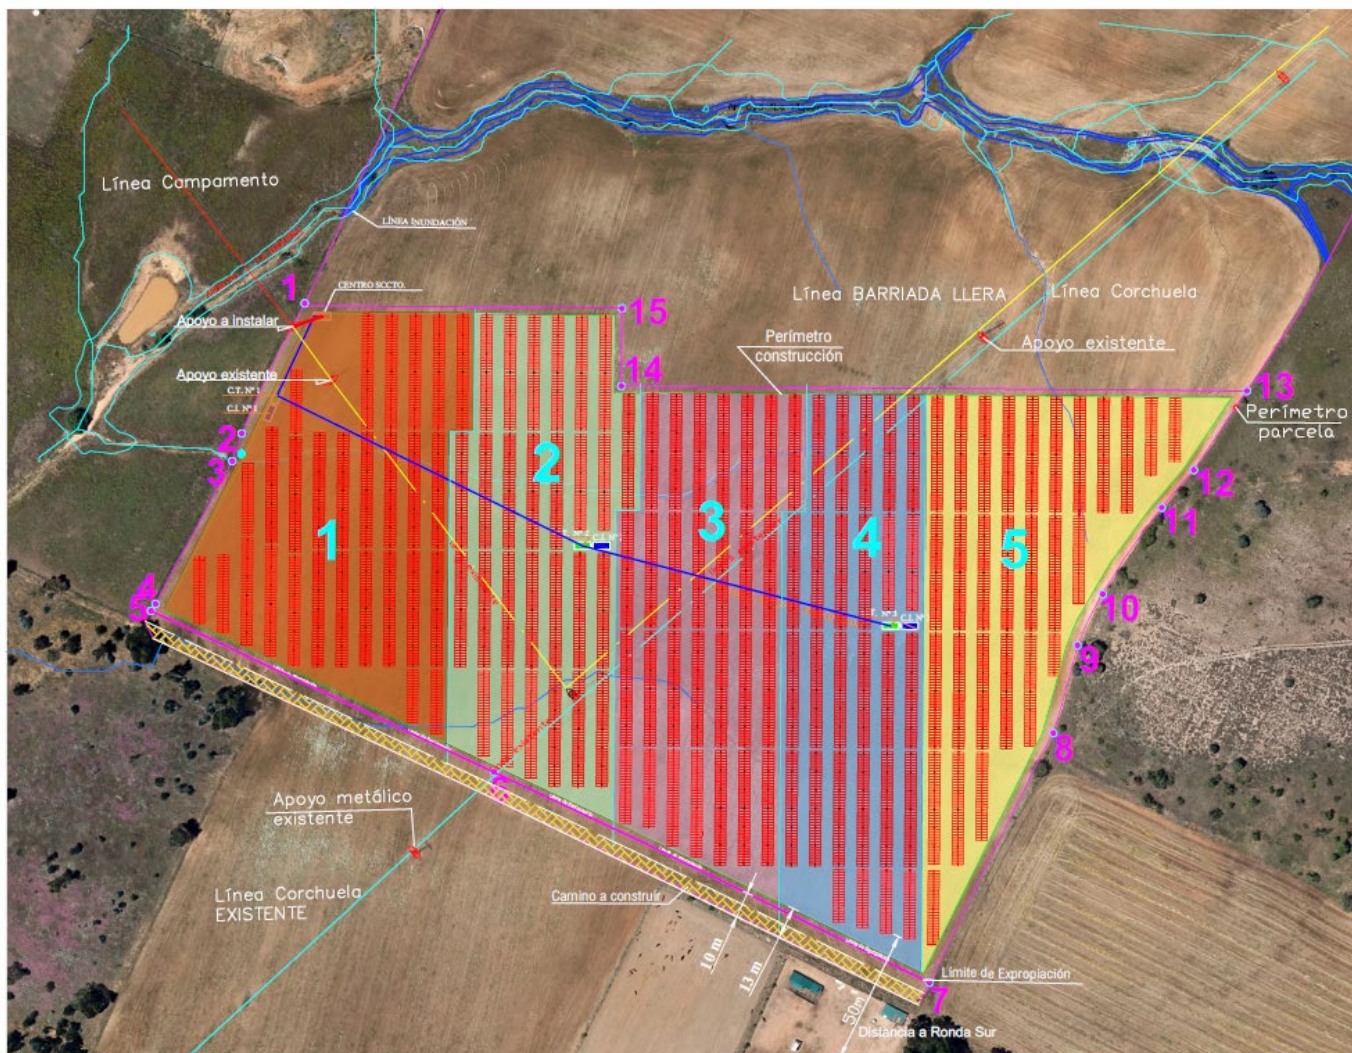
Doc. I. Memoria – Plano de las subinstalaciones de la planta FV
